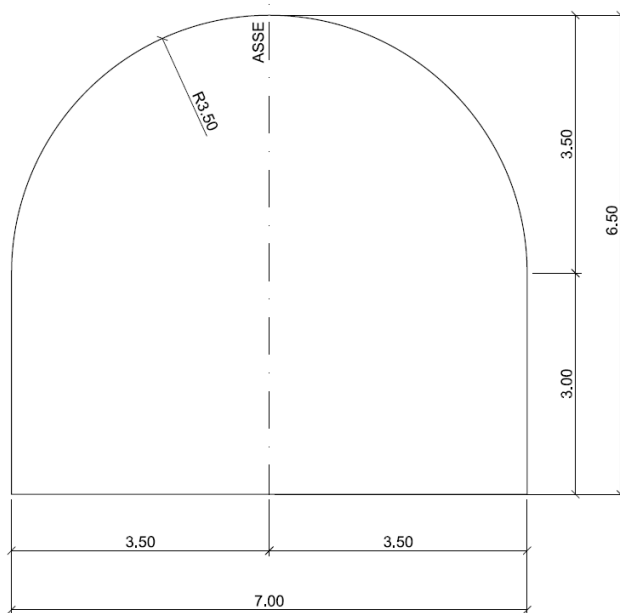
Sezione Analizzata Tipo 1 Galleria Di Accesso Al Pozzo Paratoie
